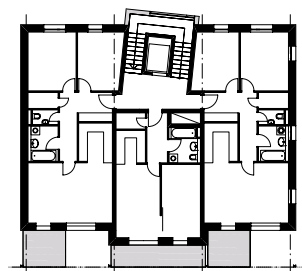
Utendorfgasse - Grundriss des Regelgeschosses eines der drei Stiegen
